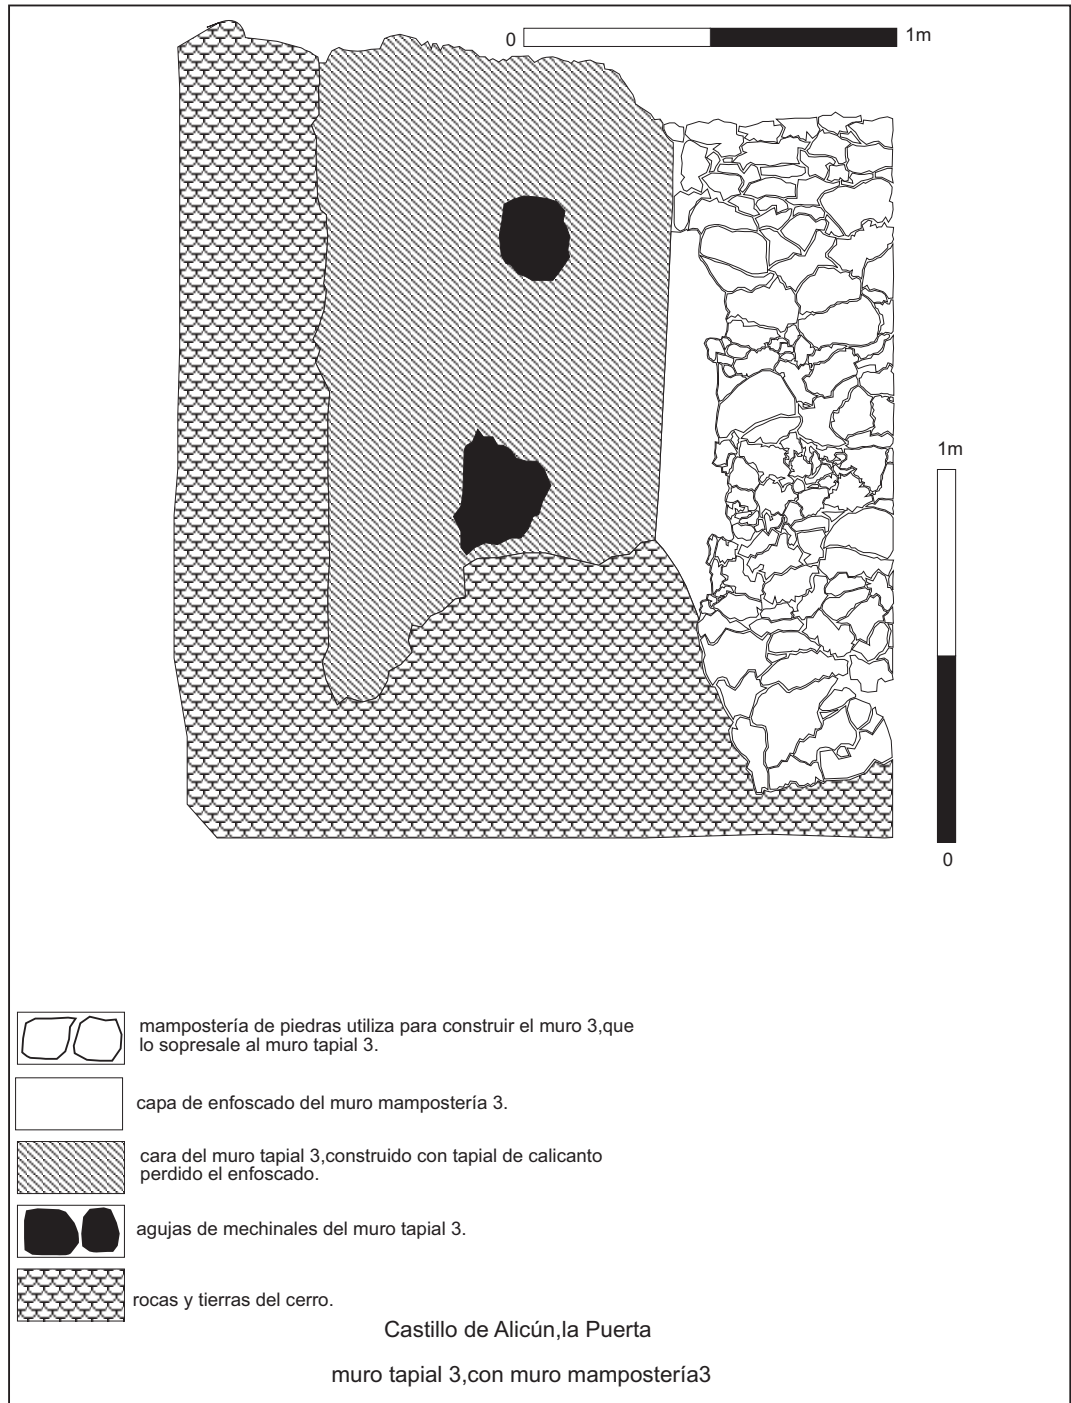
Castillo de Alicún, muro tapial 3 y muro mampostería 3 en su cara S. La técnica constructiva, tapial de calicanto y mampostería concertada
